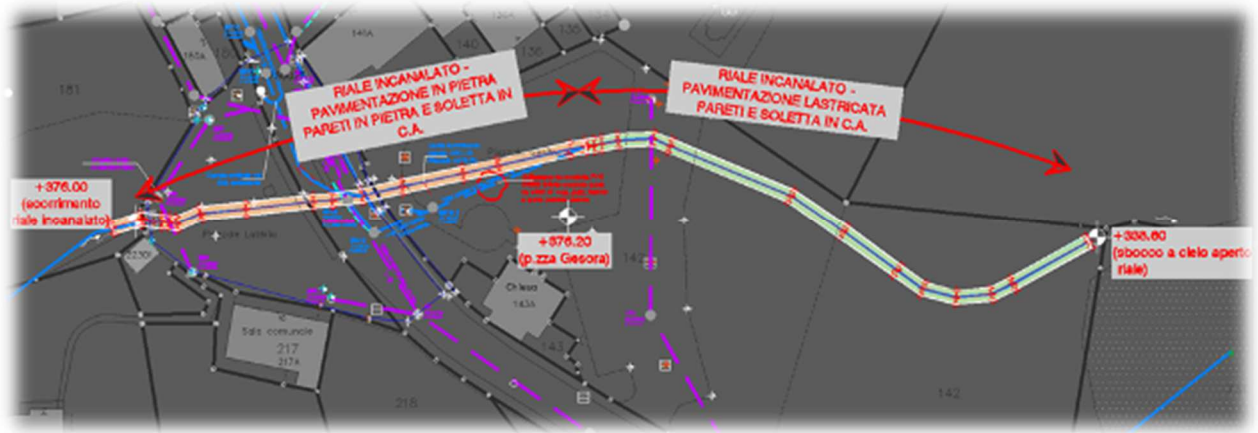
Estratto planimetrico riale, aggiornato in seguito ai rilievi di campagna
